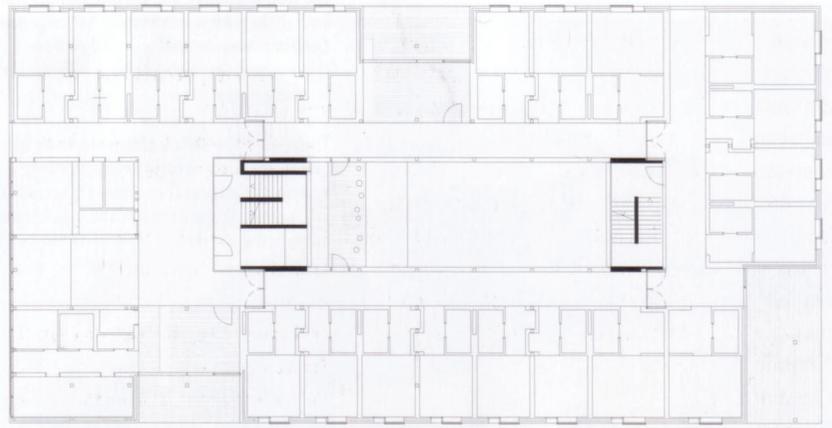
Grundriss 1. Obergeschoss M 1:500
